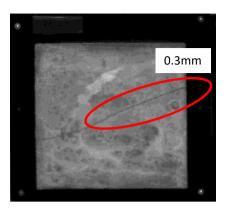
0.3mmのひび割れ模擬供試体の計測画像
